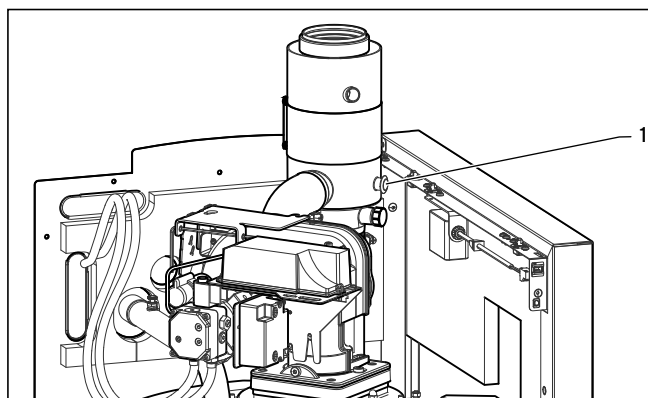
Installation de la conduite de dégazage sur l'icoVIT
